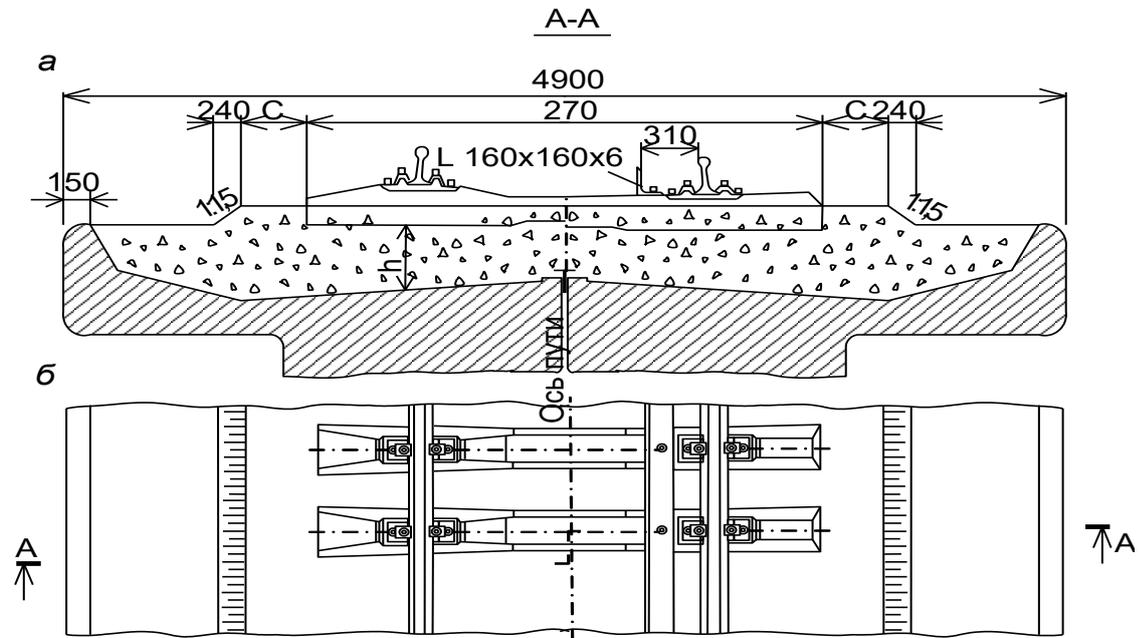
Конструкция мостового полотна с ездой на щебеночном балласте и железобетонных шпалах: а – поперечное сечение; б – план; h – толщина балласта
